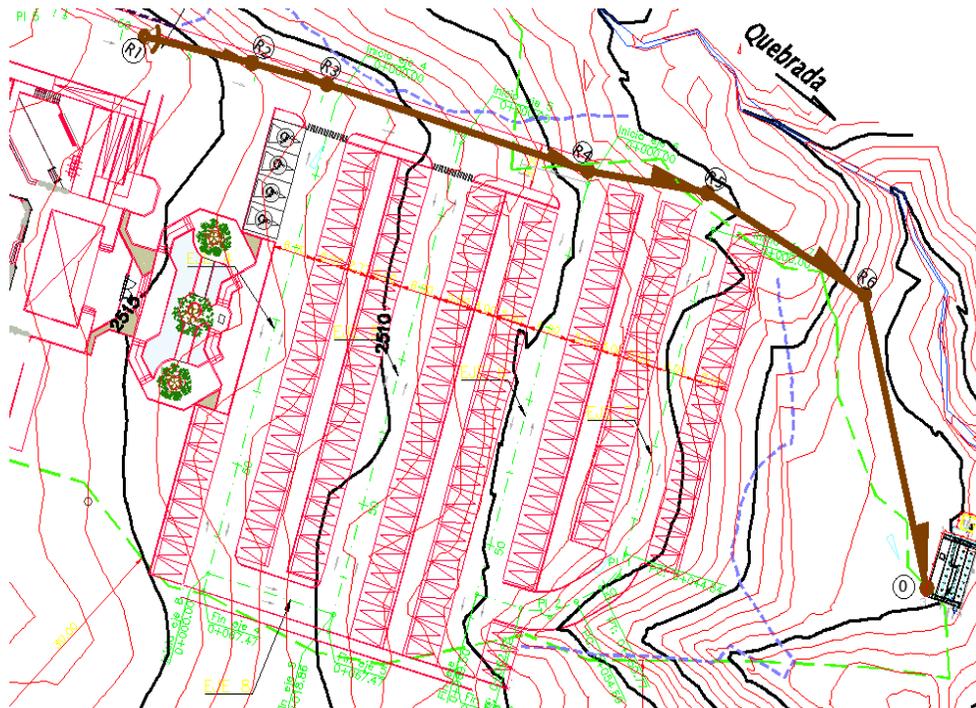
Planta de la red de alcantarillado Restaurante - Bar La Fonda de Juancho.
